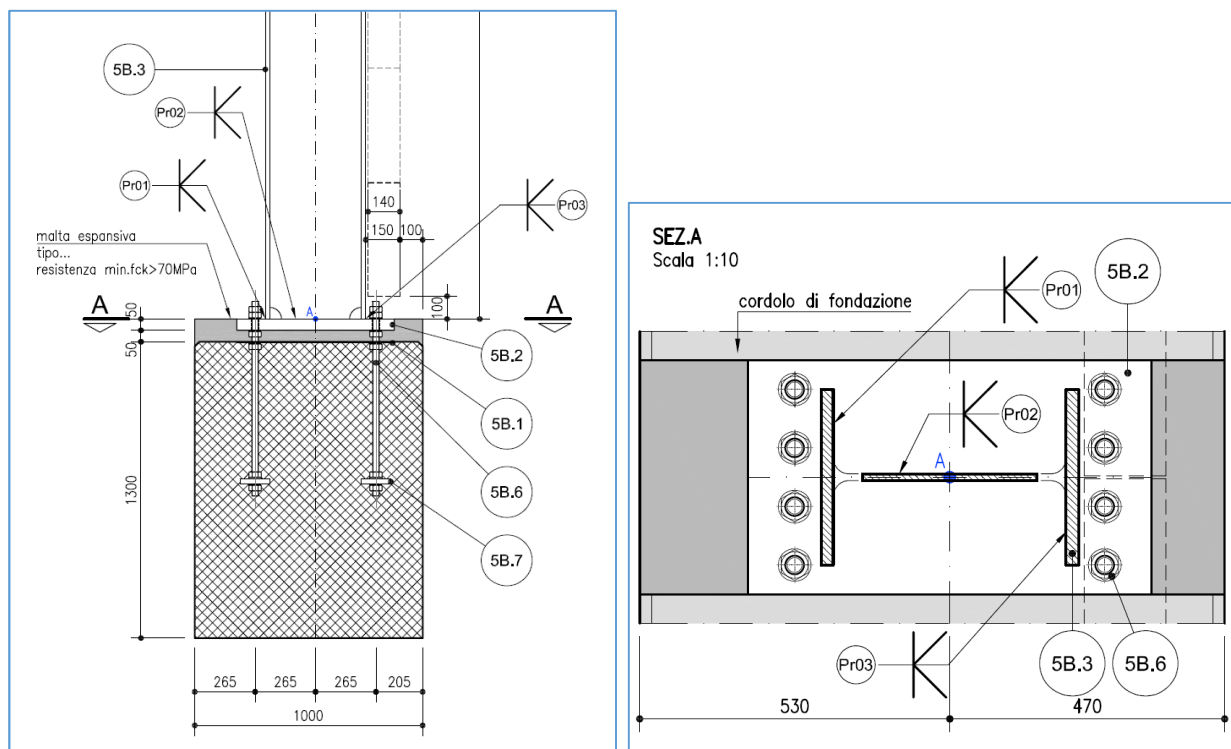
Vista di una tipica piastra di base di ancoraggio alla fondazione
